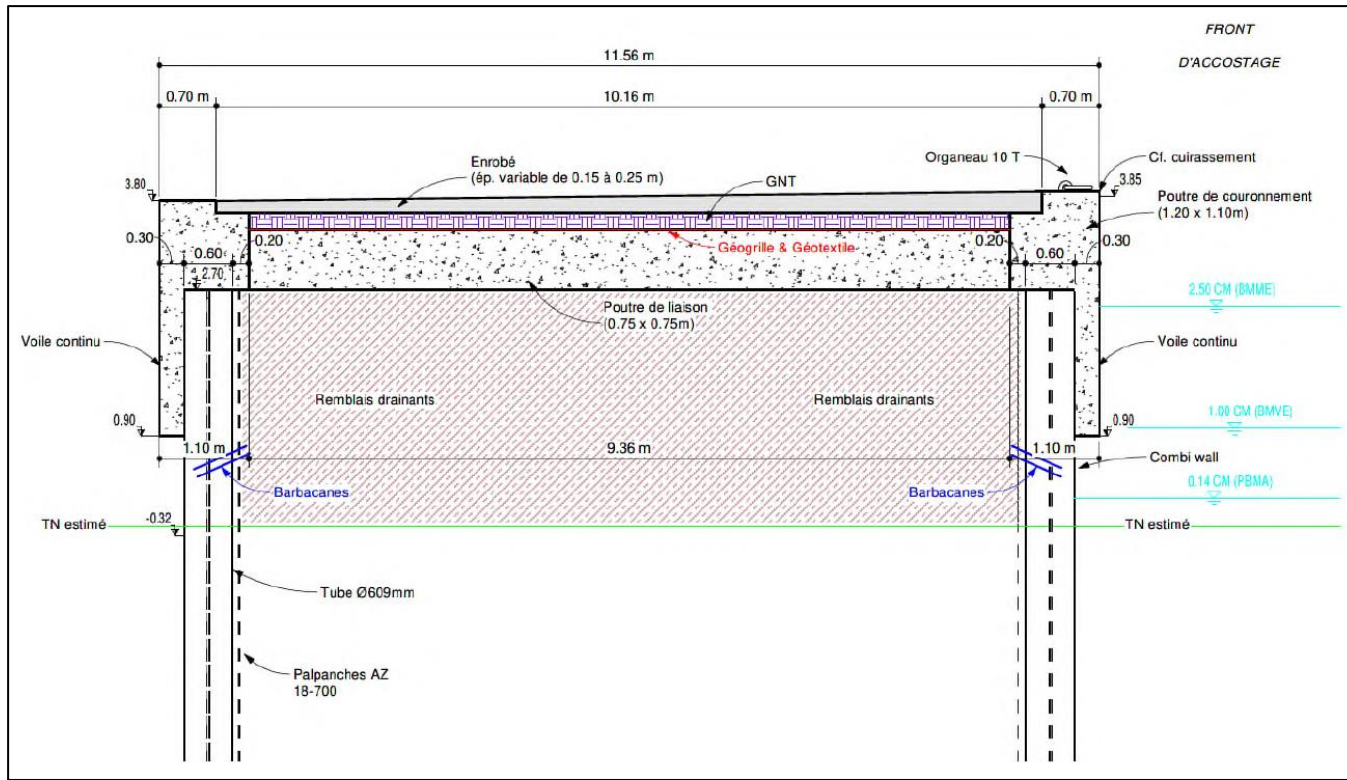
Coupe transversale de l'extension par double rideau mixte liaisonnés.
